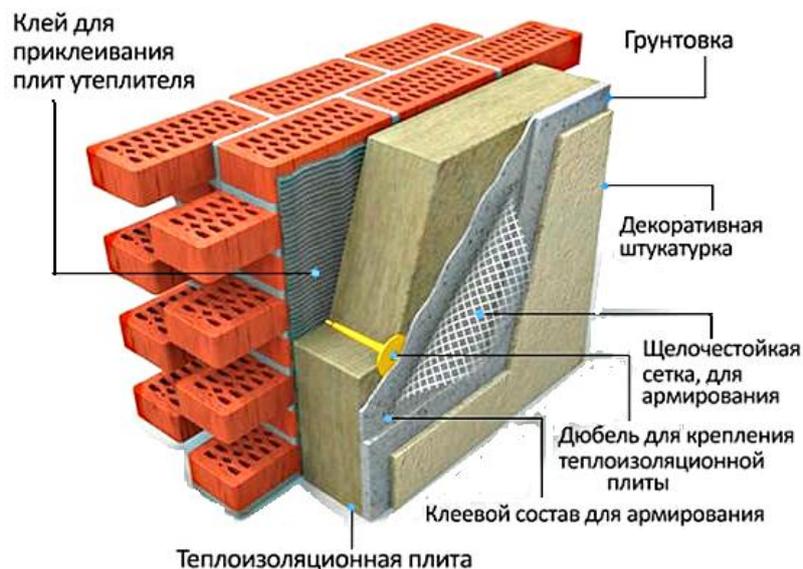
Конструкция традиционного штукатурного («мокрого») фасада здания
